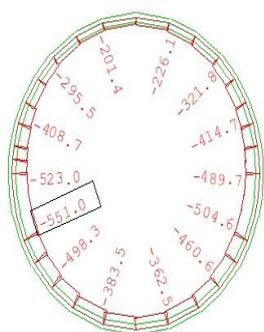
Эпюра продольных усилий, возникающая в конструкции железобетонной обделки на стадии завершения строительства тоннеля в разрезе.
